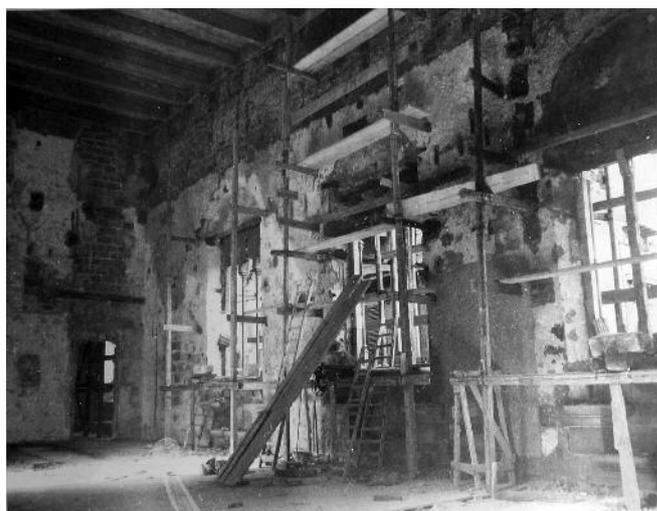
Palermo. Palazzo Abatellis, una fase del cantiere di restauro al primo piano (Archivio fotografico SBBCCAAP).
